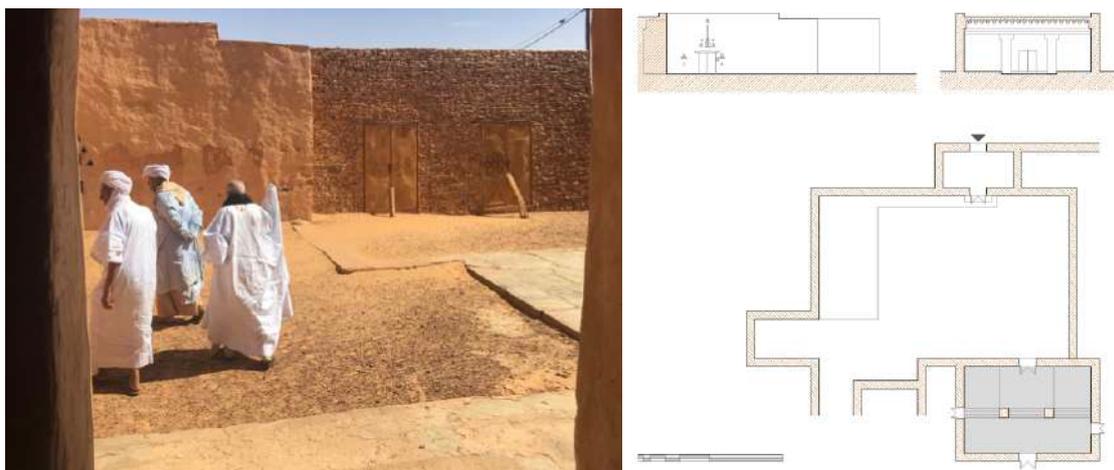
Vista para o pátio da Biblioteca Habbot e respectivos levantamentos técnicos. (Terrachidia, 2020)
